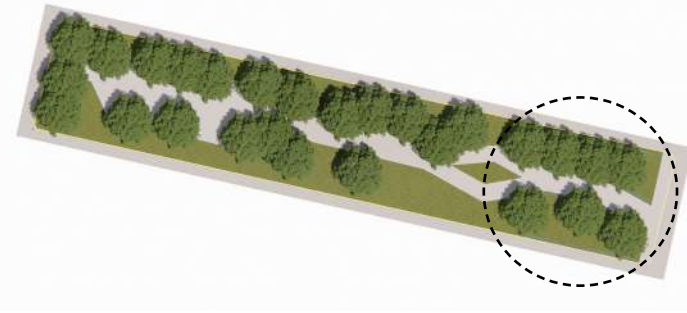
Sección tramo 4. Fuente: Elaboración propia
